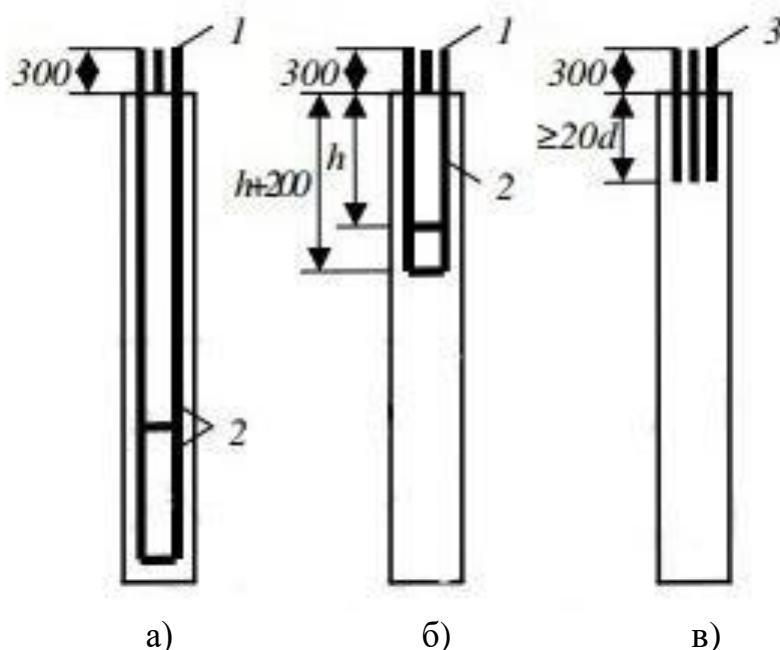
Способи армування набивних: а – на всю глибину палі;
